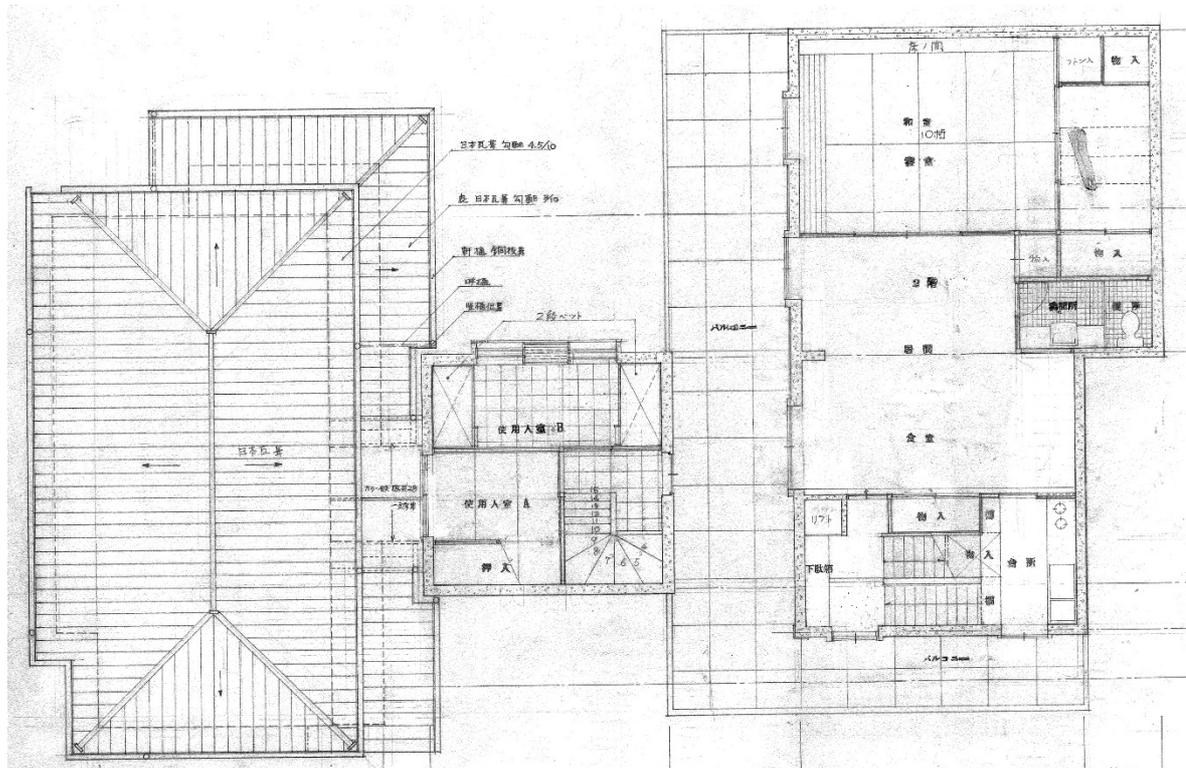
「水野レストラン」C棟屋根伏図・B棟A棟2階平面図
